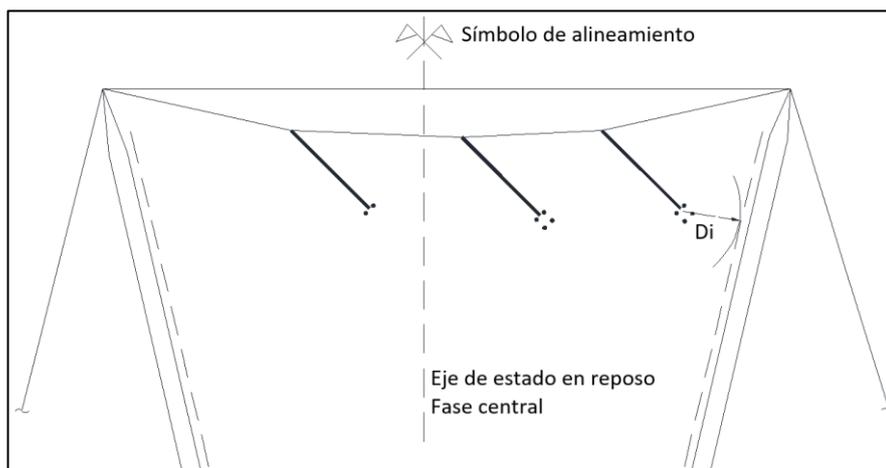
Desplazamiento horizontal de los puntos de apoyo de las cadenas de suspensión, en estructuras tipo cross rope, con viento máximo
